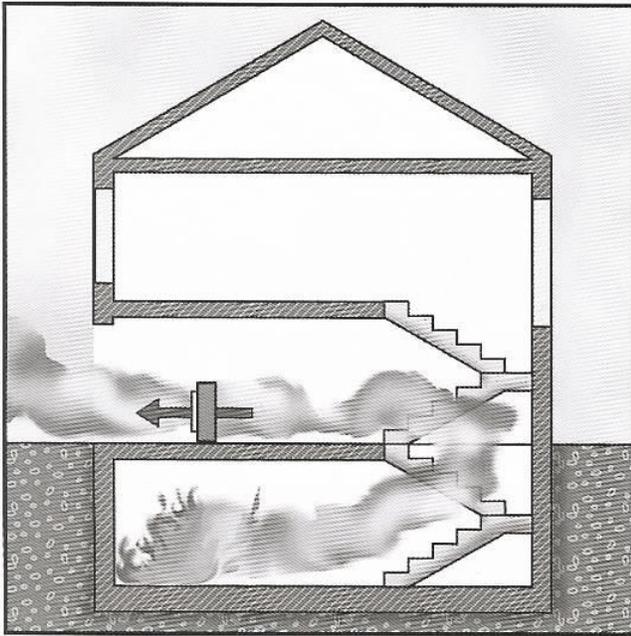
Se pueden usar las escaleras para ventilar un sótano.
